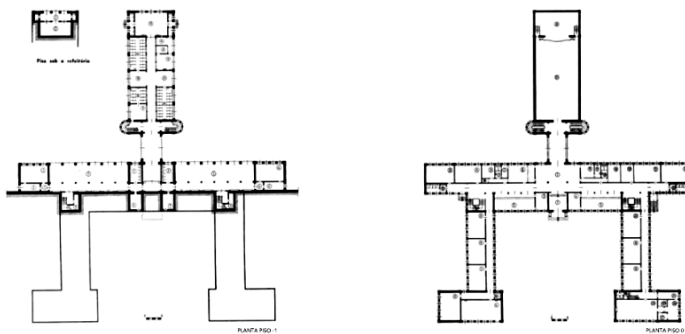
Projeto do liceu de Alves Martins – Planta piso -1; Planta piso 0
